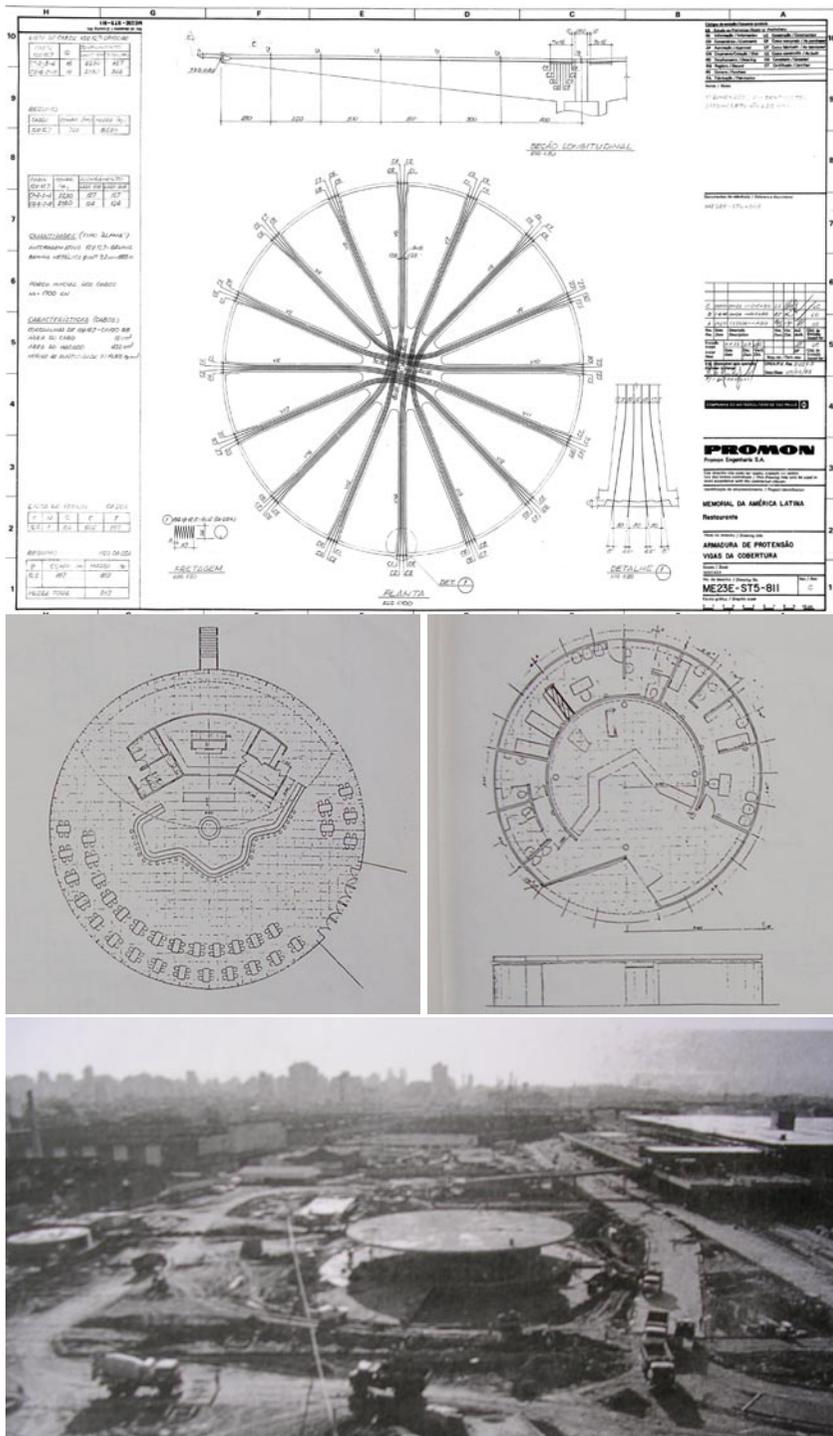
a 35: Planos y foto referentes a la solución estructural encontrada por el calculista para la forma circular proyectada por Niemeyer.
